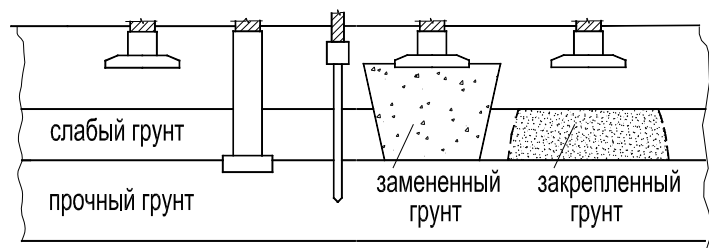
Варианты устройства фундаментов при напластовании грунтов по схеме 4(рис. 2.5).
